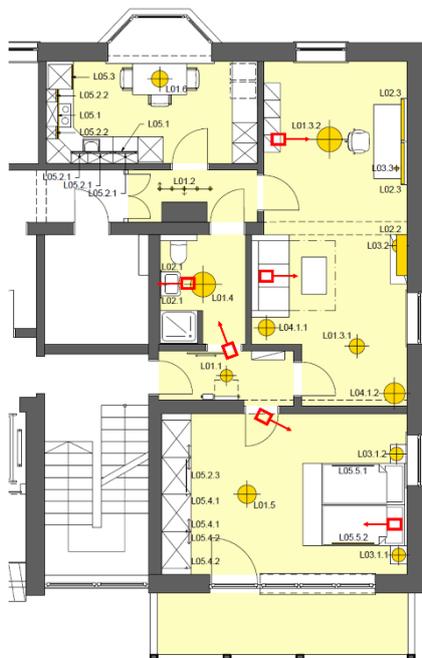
Grundriss mit Messpositionen; Pfeile geben jeweils die Blickrichtung an
